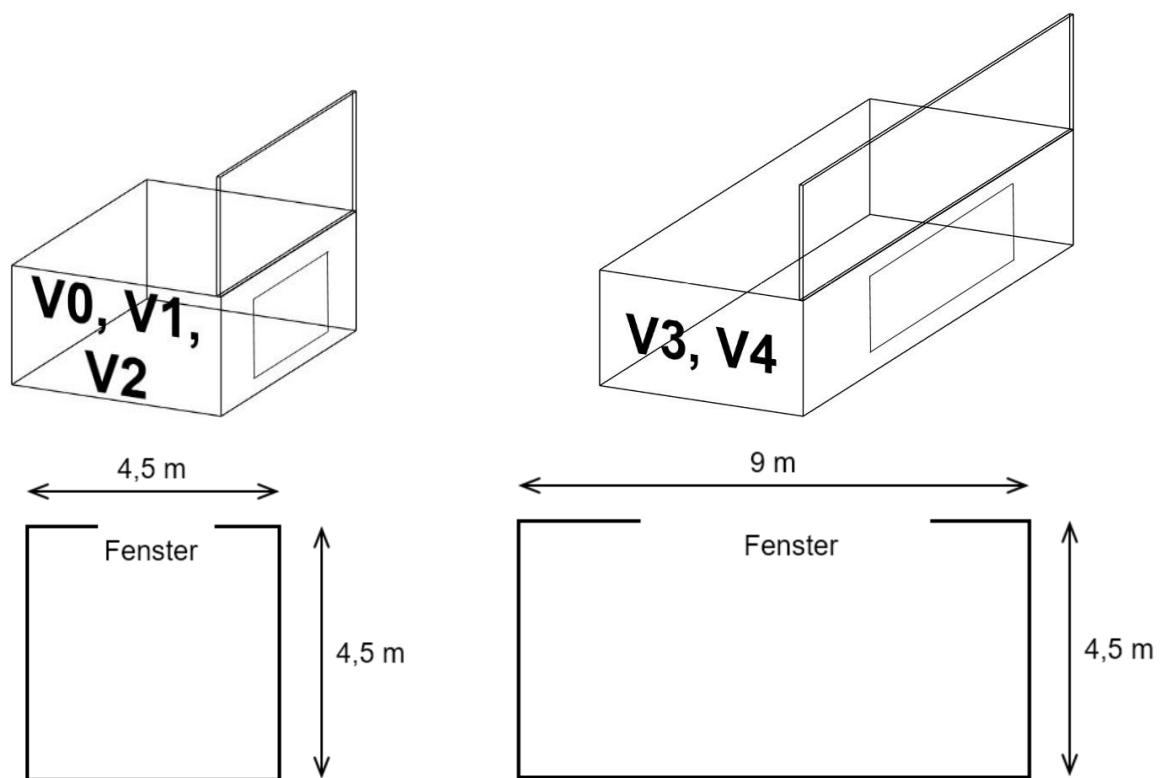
Grundrisse der fünf Realbrandversuche
